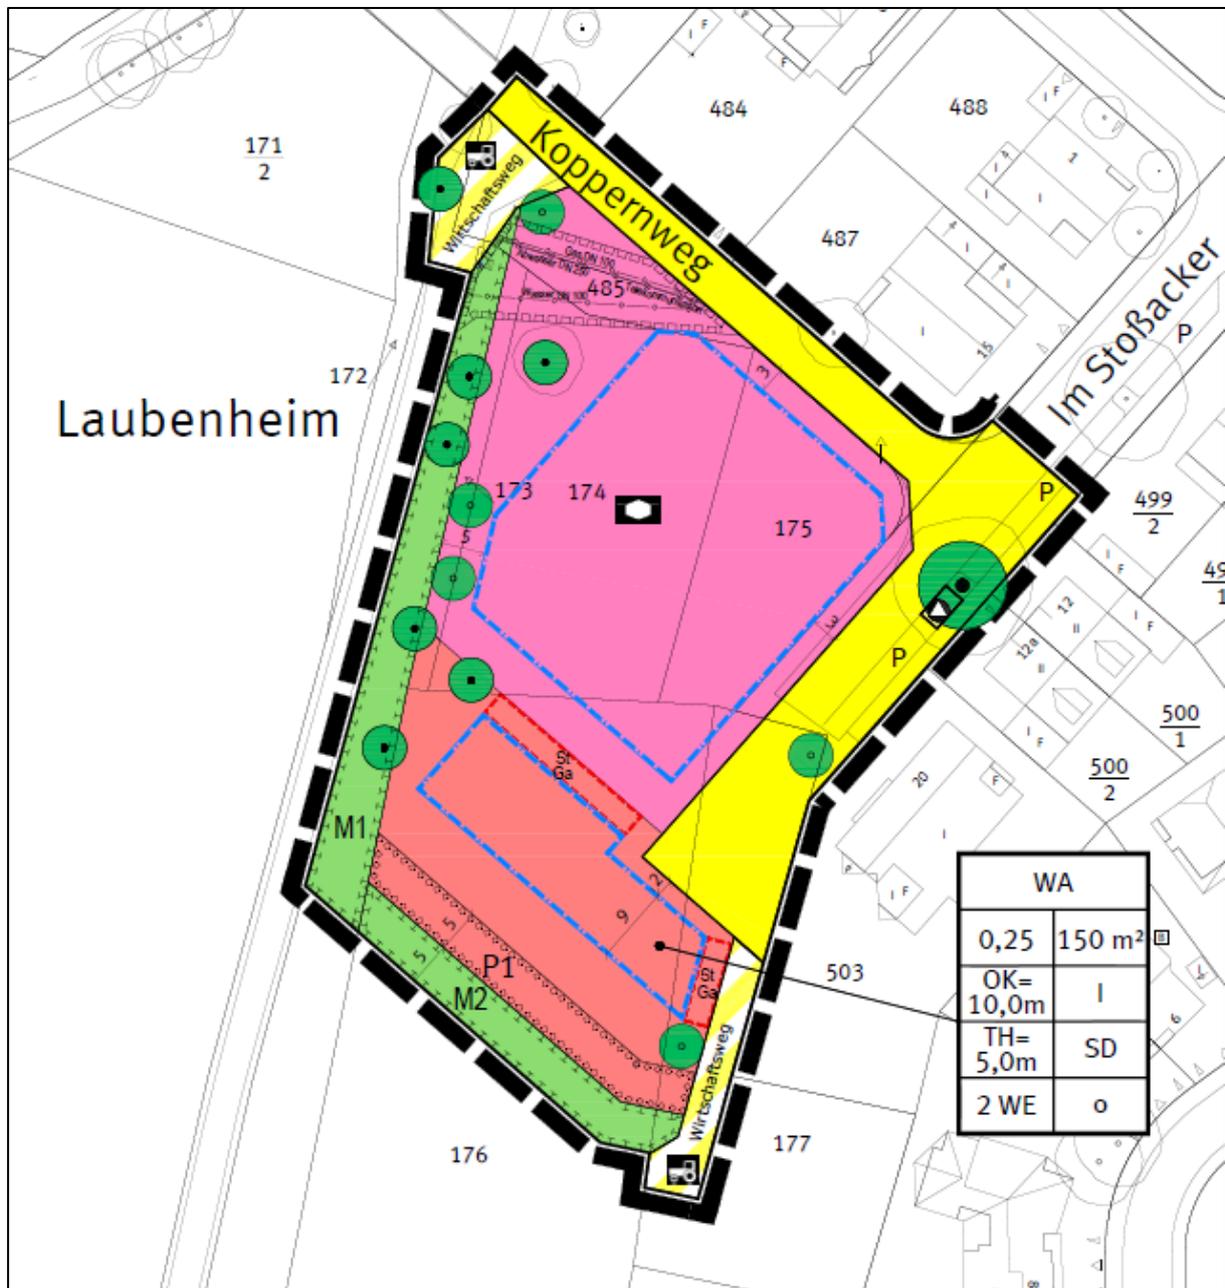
Planzeichnung des Geltungsbereichs (Quelle: STADT MAINZ 2020. Abbildung unmaßstäblich; die Legende ist dem Bebauungsplan zu entnehmen)
